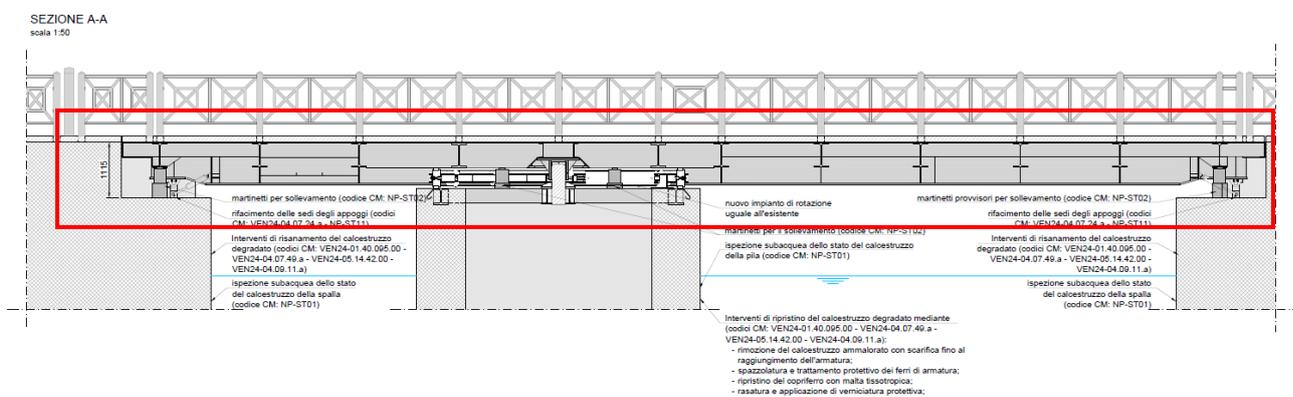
Prospetto con individuazione delle travi longitudinali.
